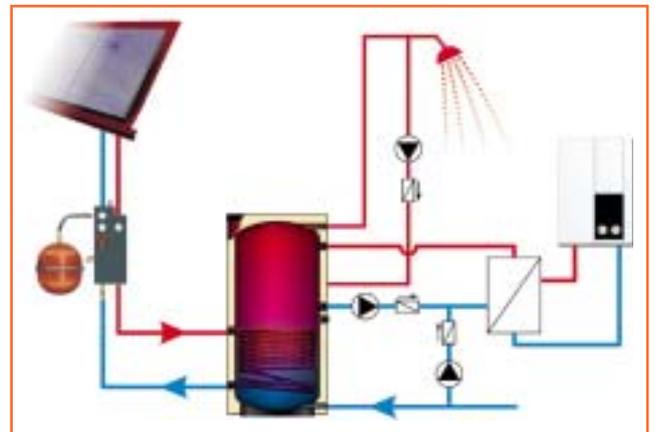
Zweikreisanlage mit einem Trinkwasserspeicher
